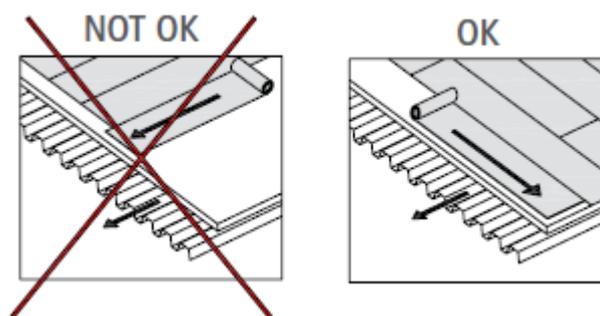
Orientação das membranas de impermeabilização em coberturas metálicas (Renolit@ 2013)
